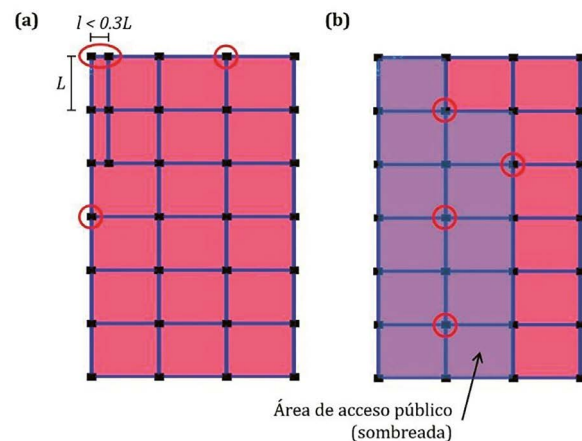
Esquema de la localización en planta de las columnas a retirar según la norma UFC 4-023-03 [5]: (a) Retirada de columnas interiores; (b) Retirada de columnas exteriores. Figura elaborada a partir de las indicaciones de la UFC 4-023-03 [5].
